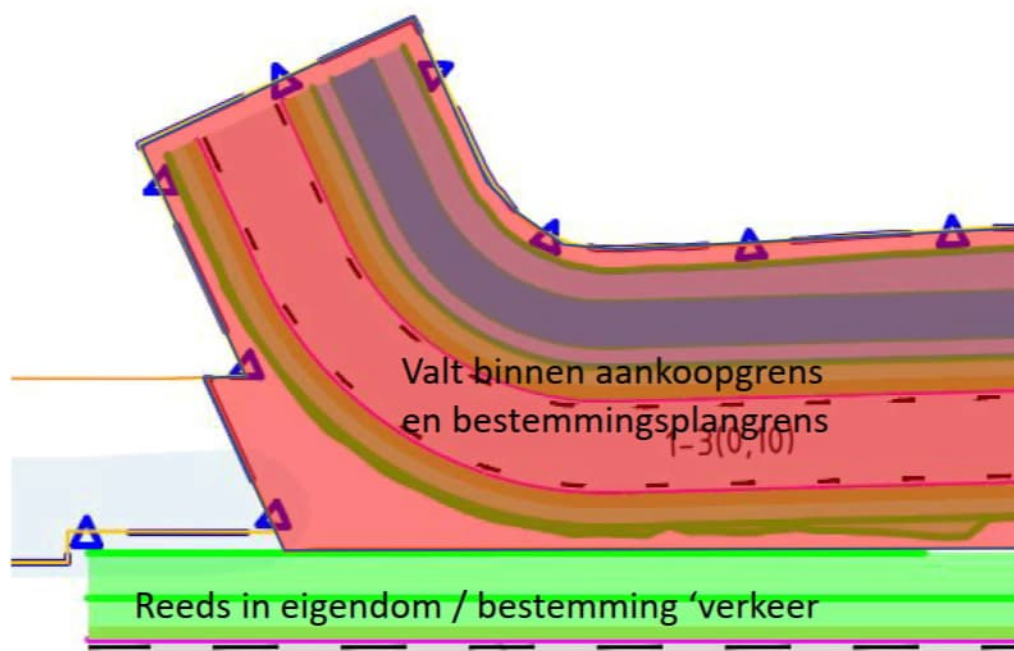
Verbeelding ontwerp met plangrens en aangepaste bestemmingsplan- en aankoopgrens
